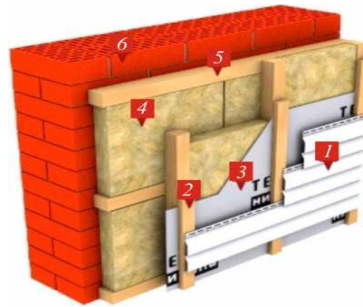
Приклад конструкції навісного вентиляваного фасаду:
